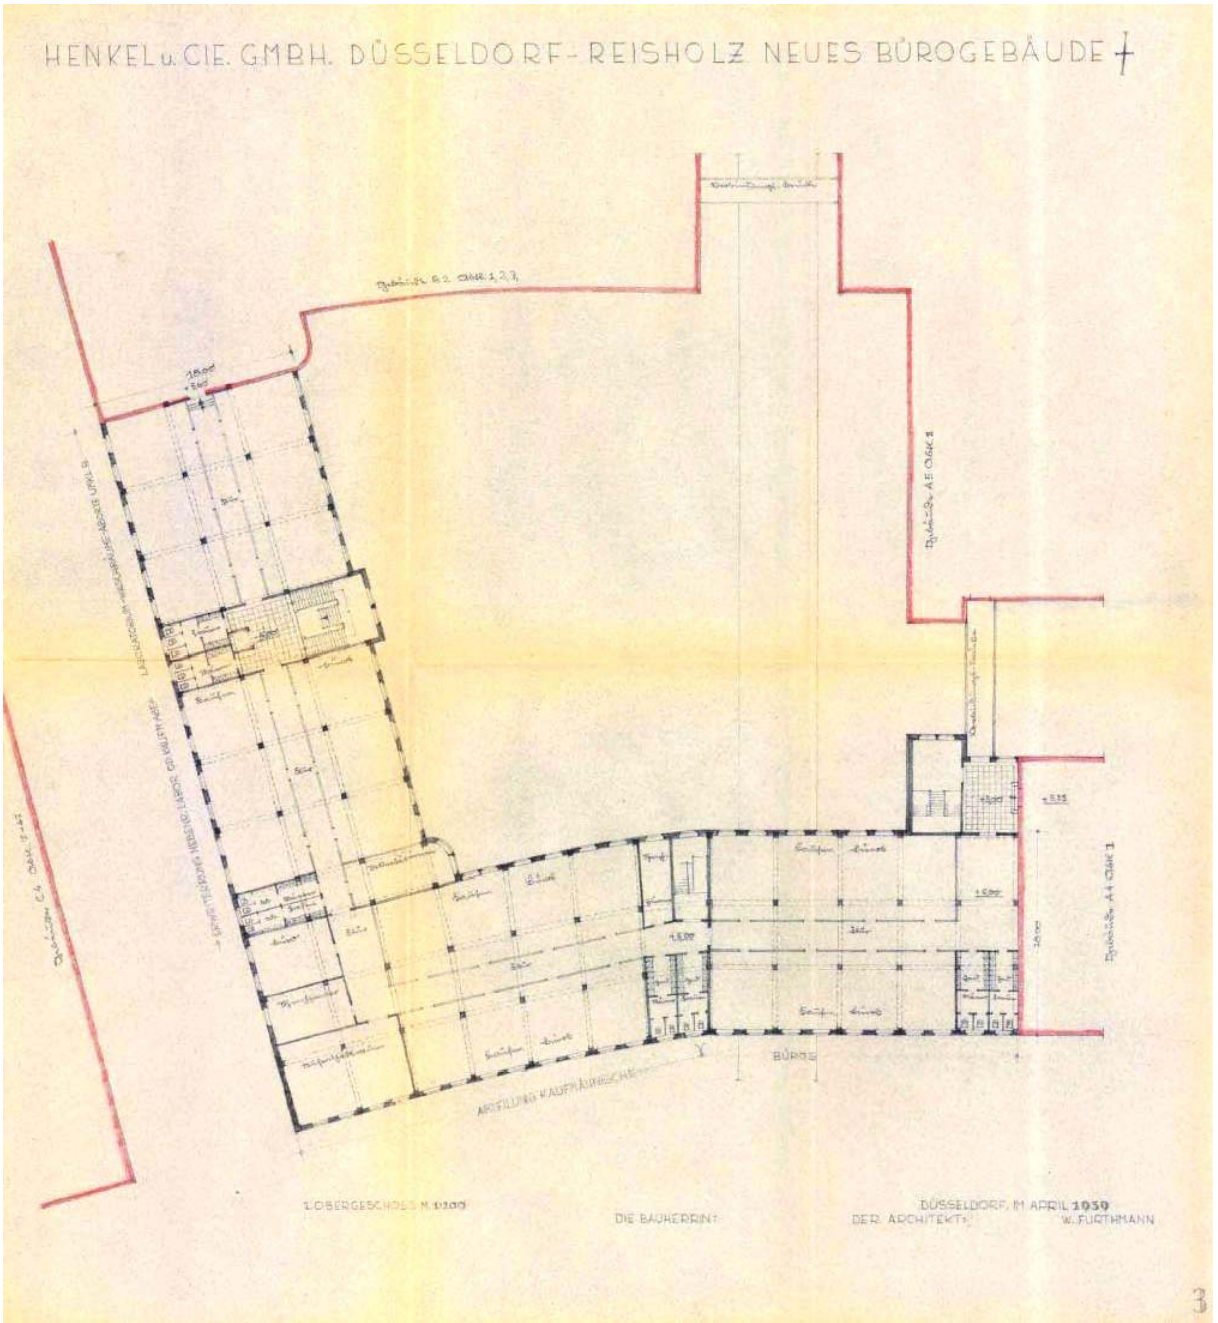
Entwurf zum Bürogebäude, Grundriss-1.Obergeschoss, April 1939 – Arch.: W. Furthmann
